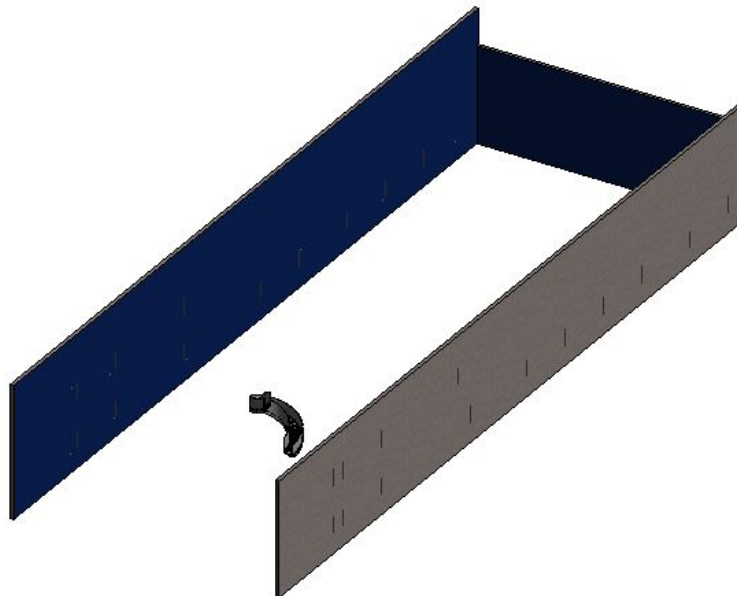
Fase 3: Cerramiento paredes y construcción escalera
